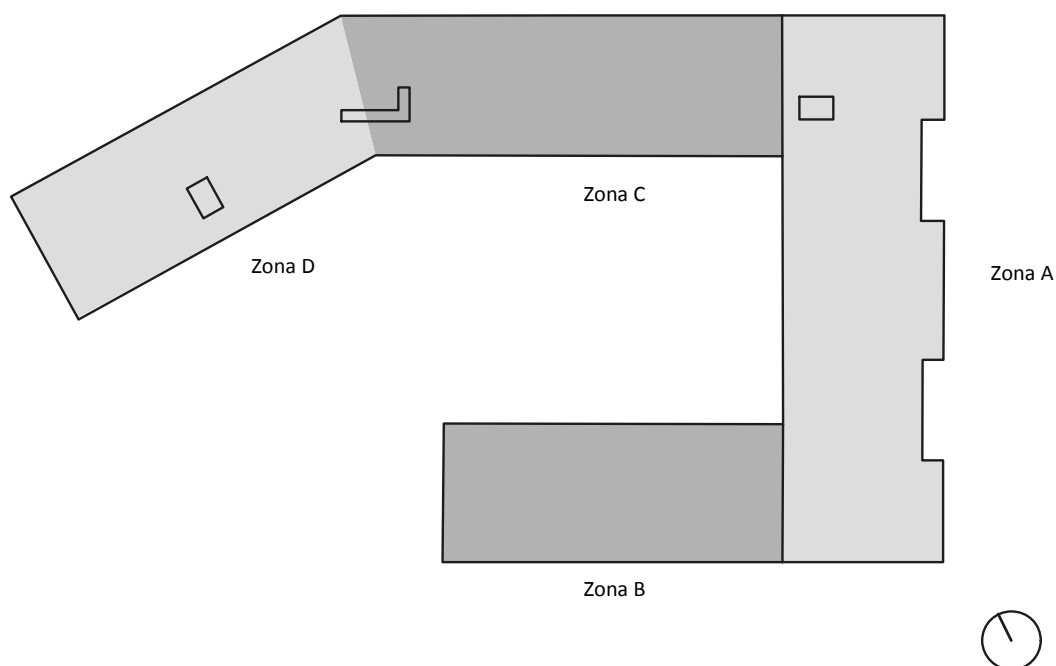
Plano de cubiertas Rectorado Edificio B
